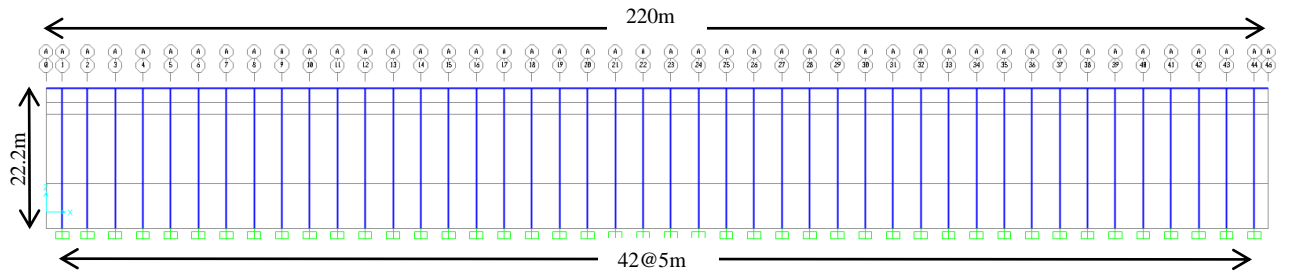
Vista en elevación del plano A de geometría, paralelo a plano X-Vertical.
